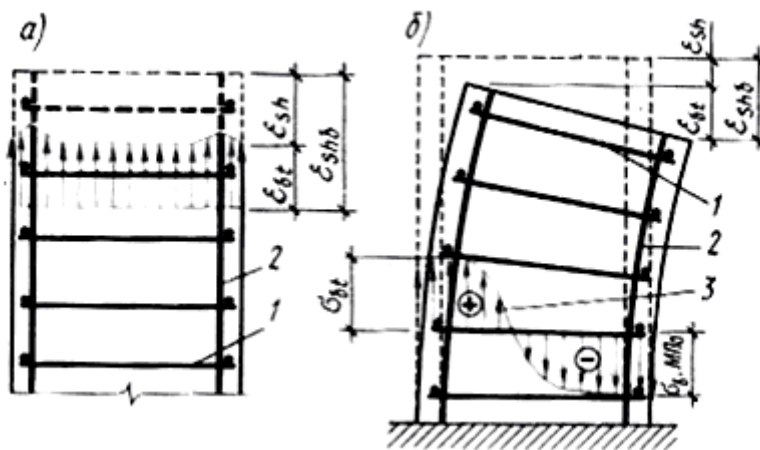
Схема деформації армованого елемента від усадки бетону:
